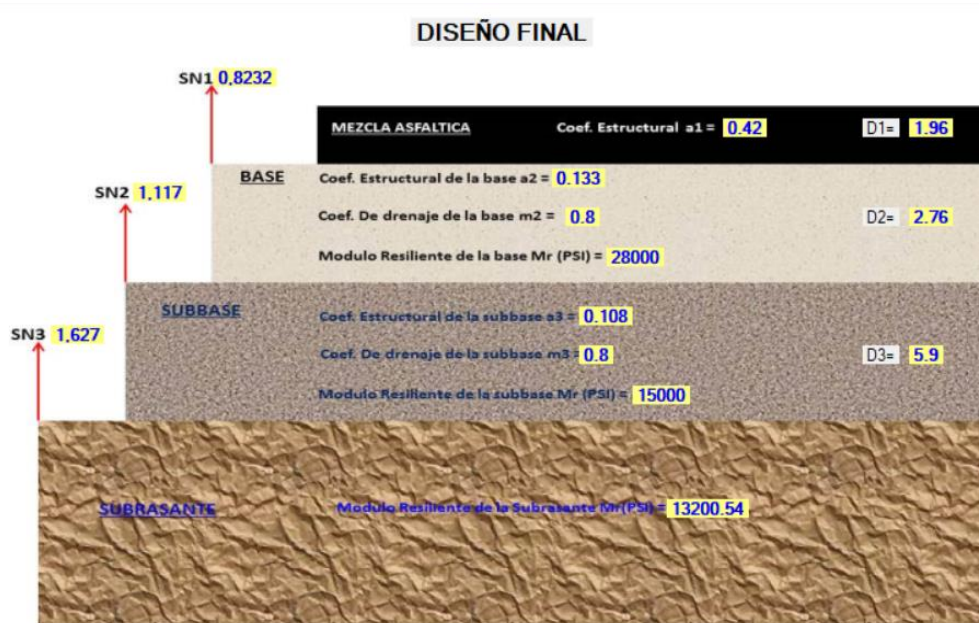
Estructura de pavimento mezclado en caliente para ciclovía del proyecto
